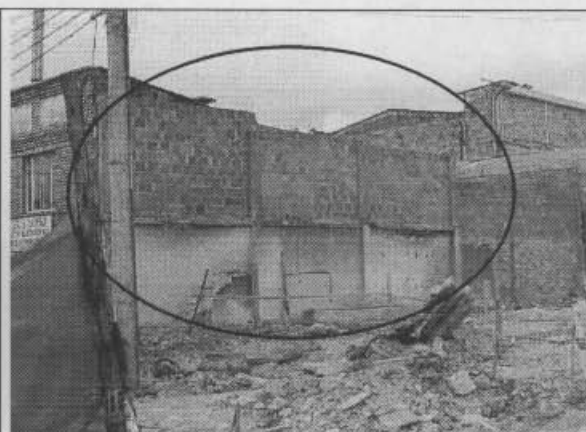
Costado lateral del inmueble, las demoliciones adelantadas en el sector han dejado en evidencia las características de la construcción.
